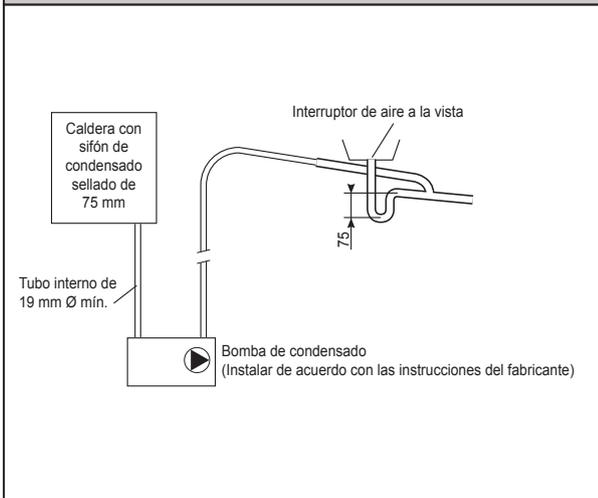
Conexión del tubo de drenaje de condensado a un bajante de desagüe externo
